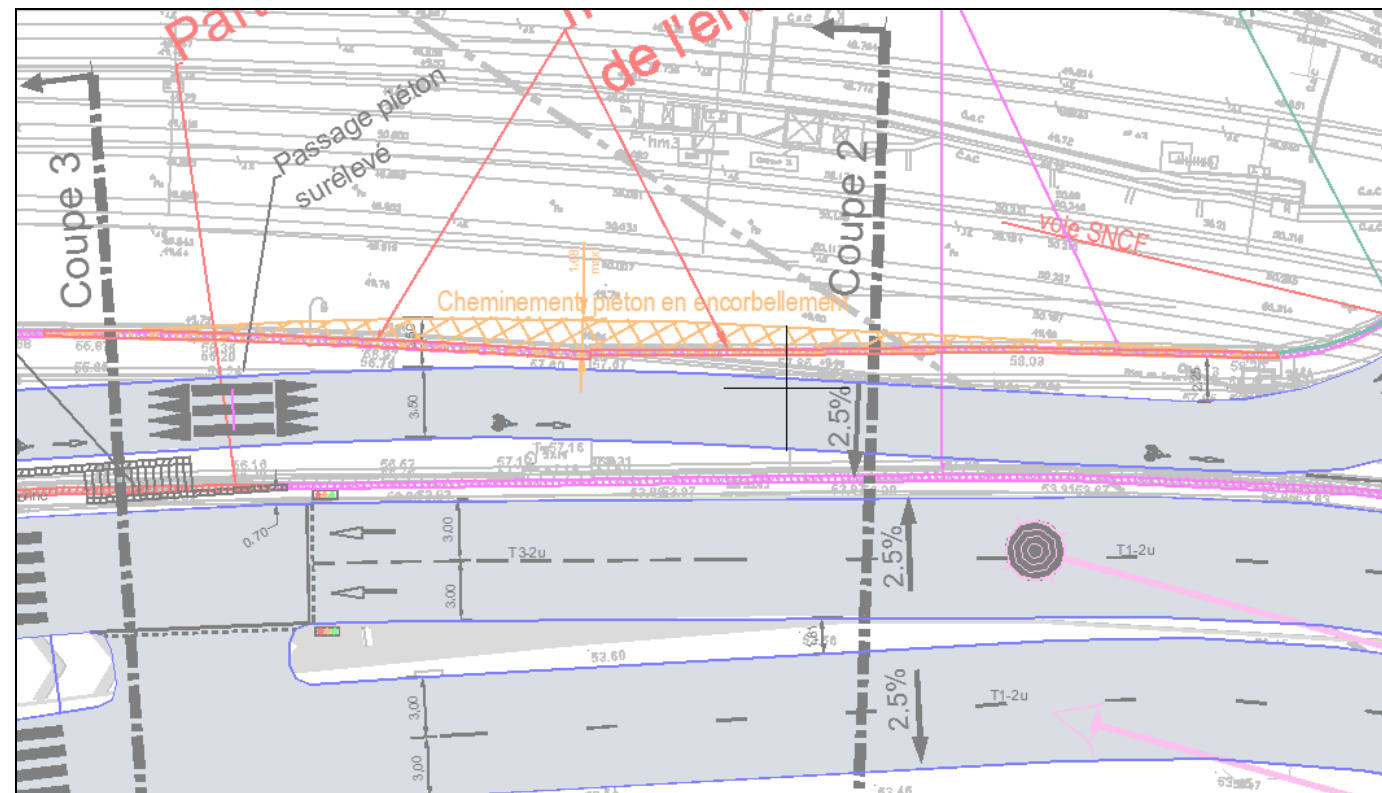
Vue en plan au droit de la rue Léonard de Vinci et du trottoir en encorbellement
